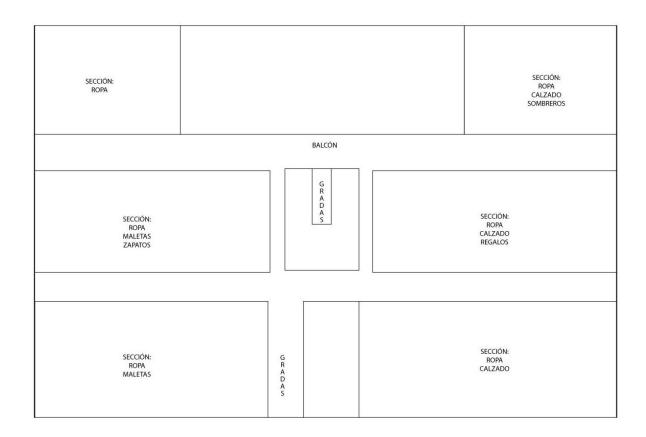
Planta alta Centro Comercial la Condamine Elaboración: Margarita Guamán Durán
